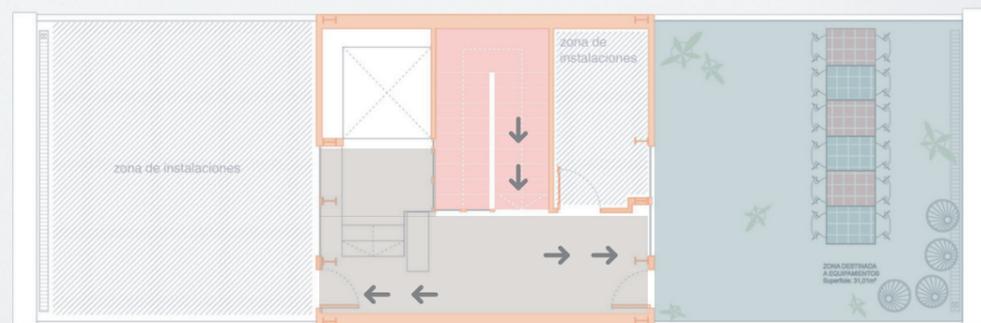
Planta baixa 3º pavimento Coworking Utopicus
